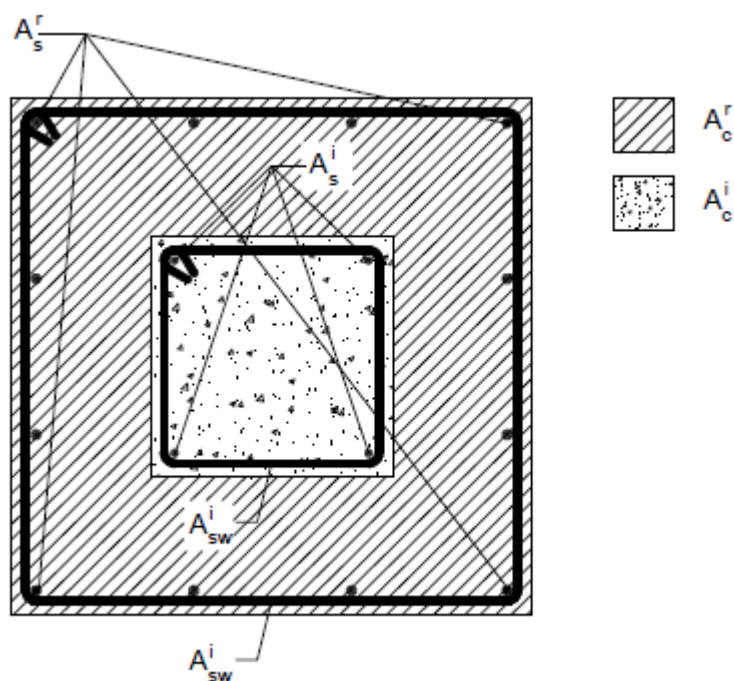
Pilar com encamisamento de betão armado total (Álvaro Sousa, 2008).
